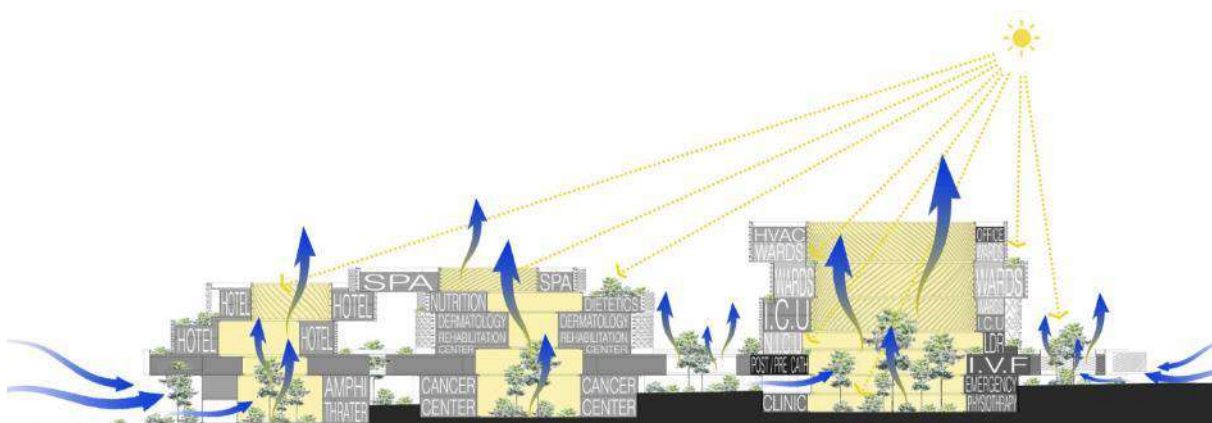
Розріз та схема освітлюваності і вентиляції будівлі [3]
